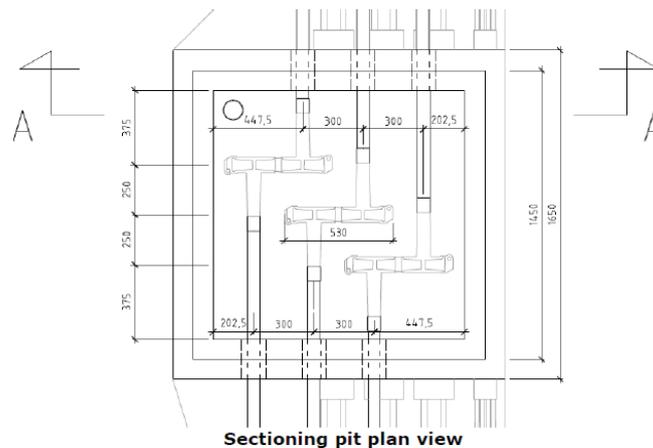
Vista in pianta dei giunti sconnettibili all'interno dei pozzettoni di sezionamento
